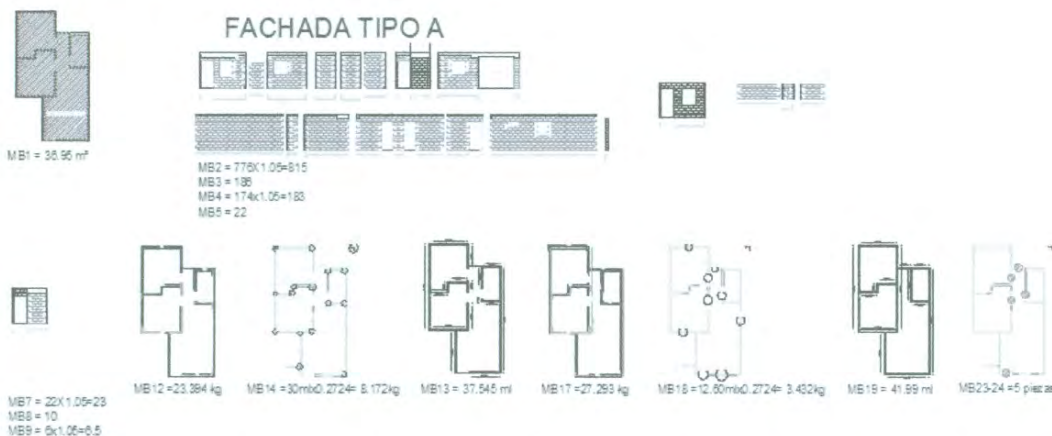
Plano de muros en planta baja para cubicar las cantidades de insumos
